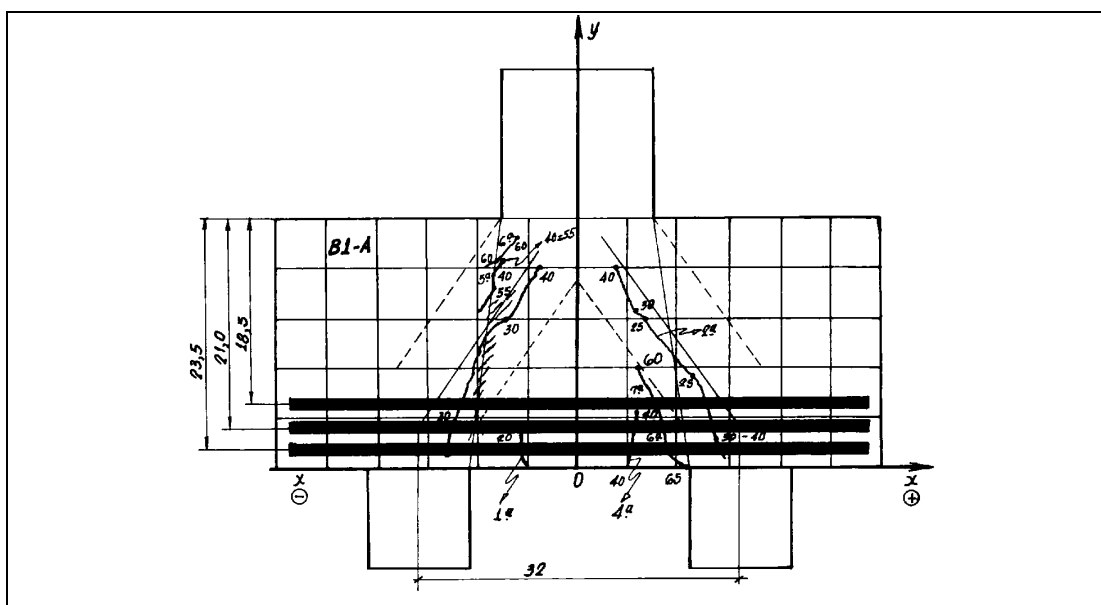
Configuração geométrica do bloco B1-A ensaiado por Mautoni (1972) e fissuras desenvolvidas até a carga de 600 kN
